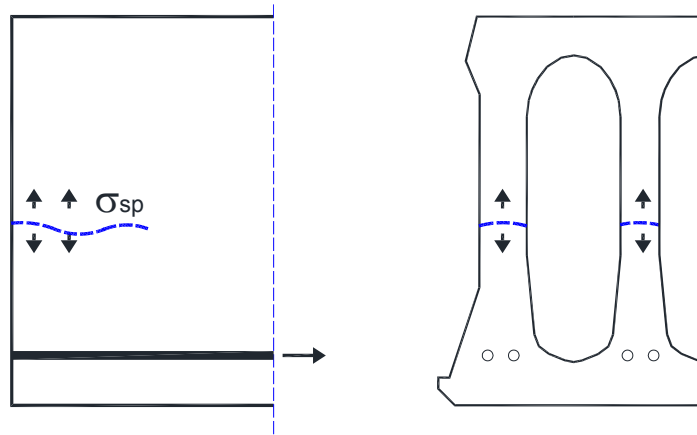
Fisuras generadas por la rotura del anclaje.
